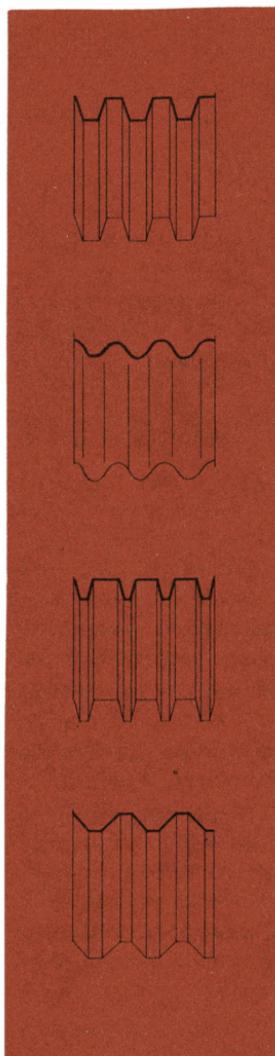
Фасады зданий со стеновым ограждением из металлического листа
